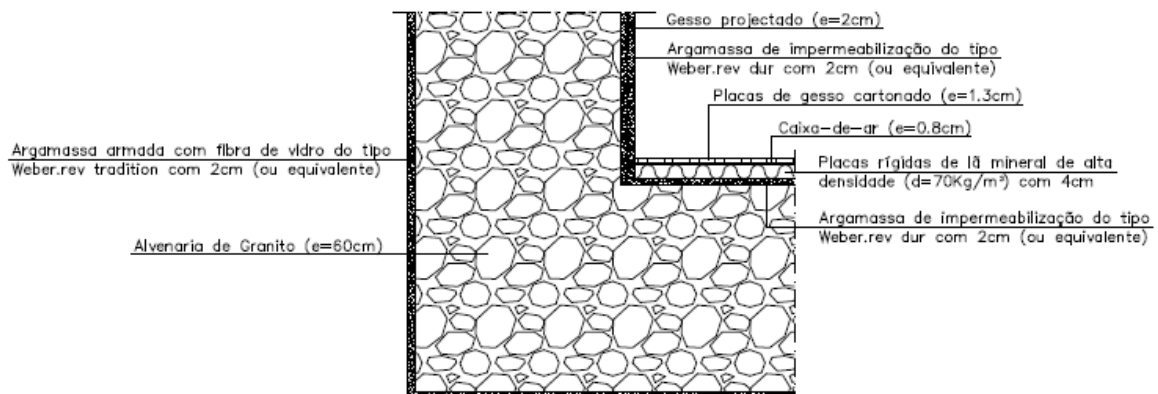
Pormenor de ligação entre duas paredes exteriores verticais (Projeto de CT)
